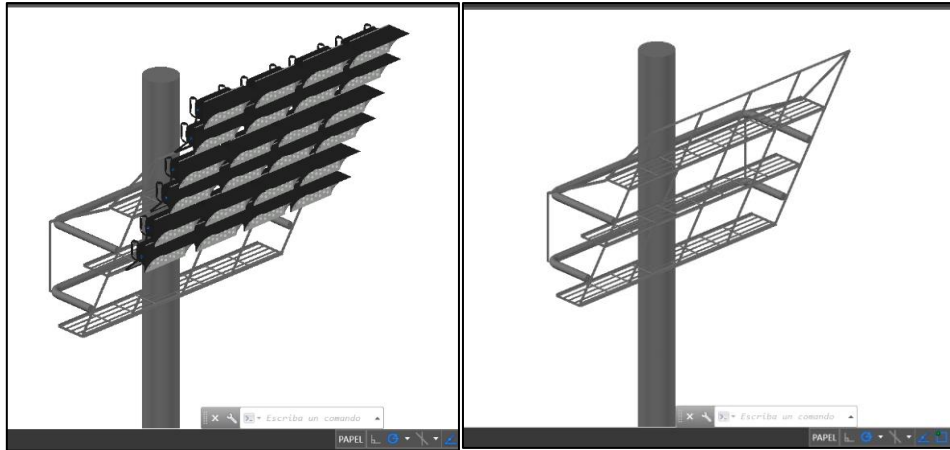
Tipo de montaje en la cancha de Futbol. Autocad 3D
